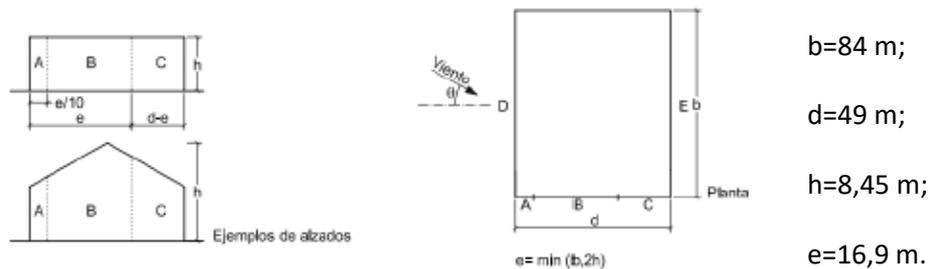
ACCIÓN DEL VIENTO EN DIRECCIÓN TRANSVERSAL A LA FACHADA
